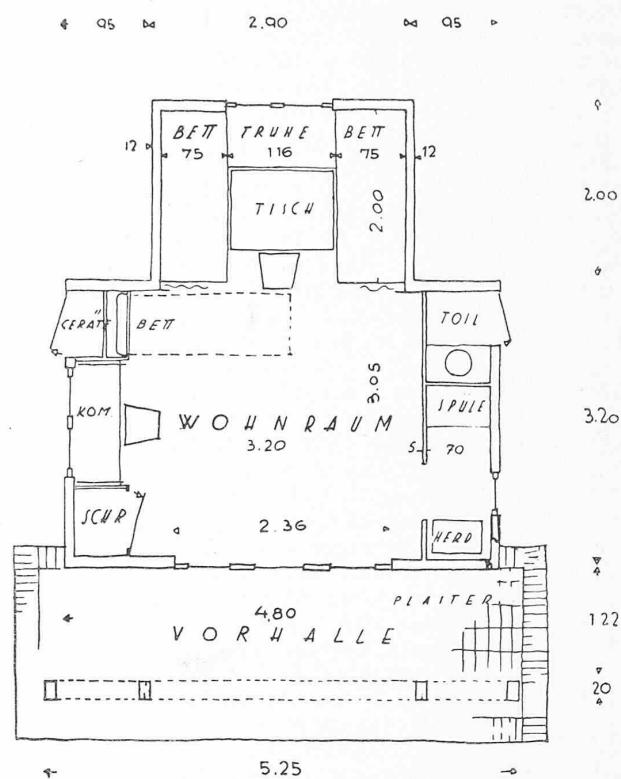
Grundriss zu Abbildung 1. Maßstab 1:75.
